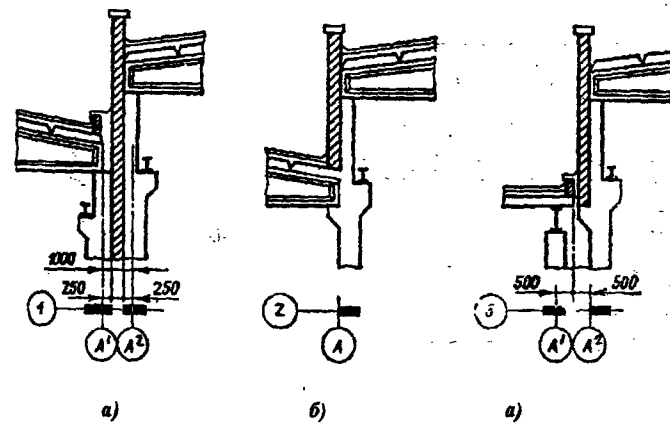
Примыкание ферм покрытия пролетов разной высоты:
